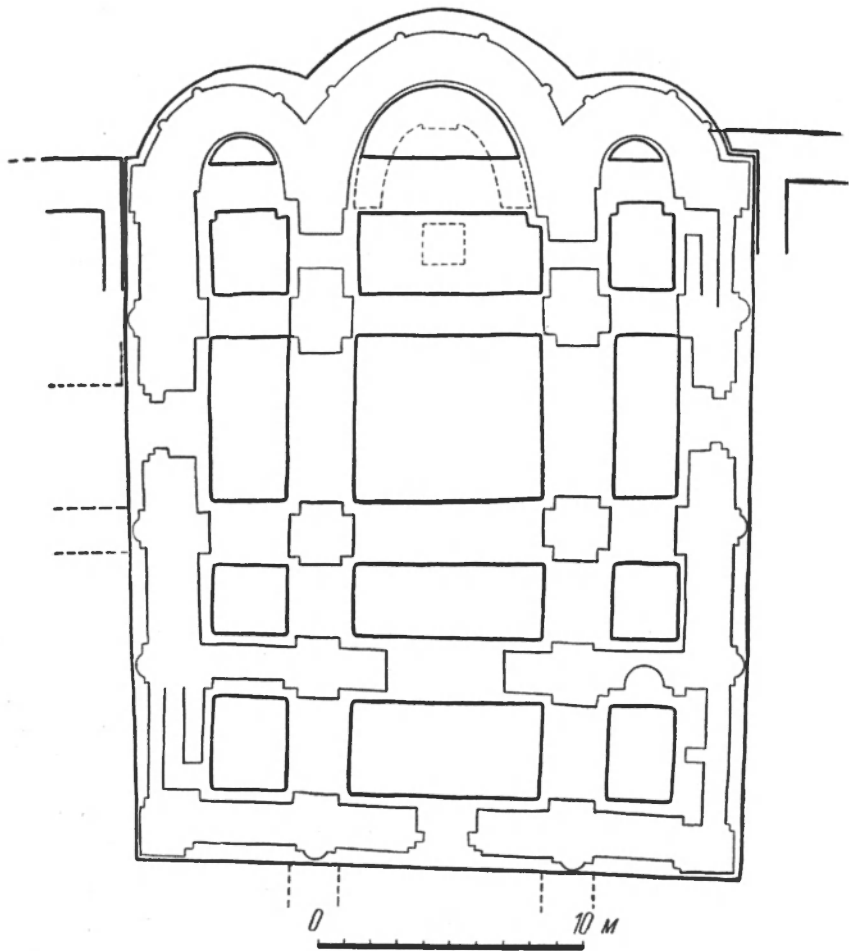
План фундаментов Кирилловской церкви (по краям показаны обнаруженные бурением фундаменты пристроек)
